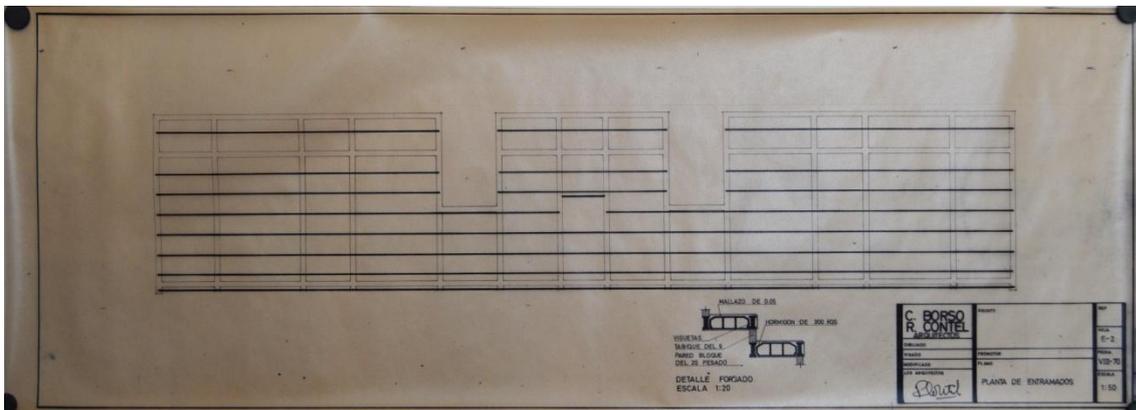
Plano distribución viguetas en las gradas. Archivo Escuelas San José.
